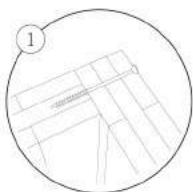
Detalhe construtivo da conexão entre painéis interiores “parede-parede” e “parede-tecto”
